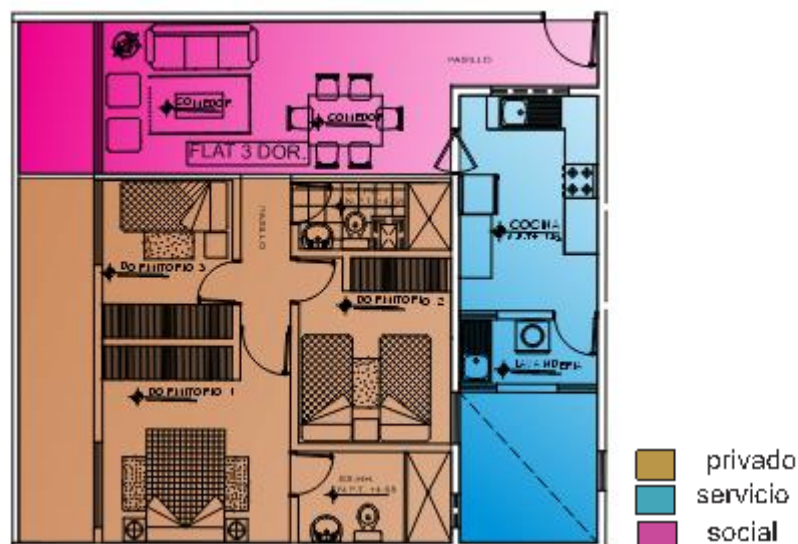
PLANO DE ZONIFICACION DEL DUPLEX CON 3 DORMITORIOS SEGUNDA PLANTA, COLORES COMO EL DORMITORIO, COCINA, SALA Y SS.HH.
